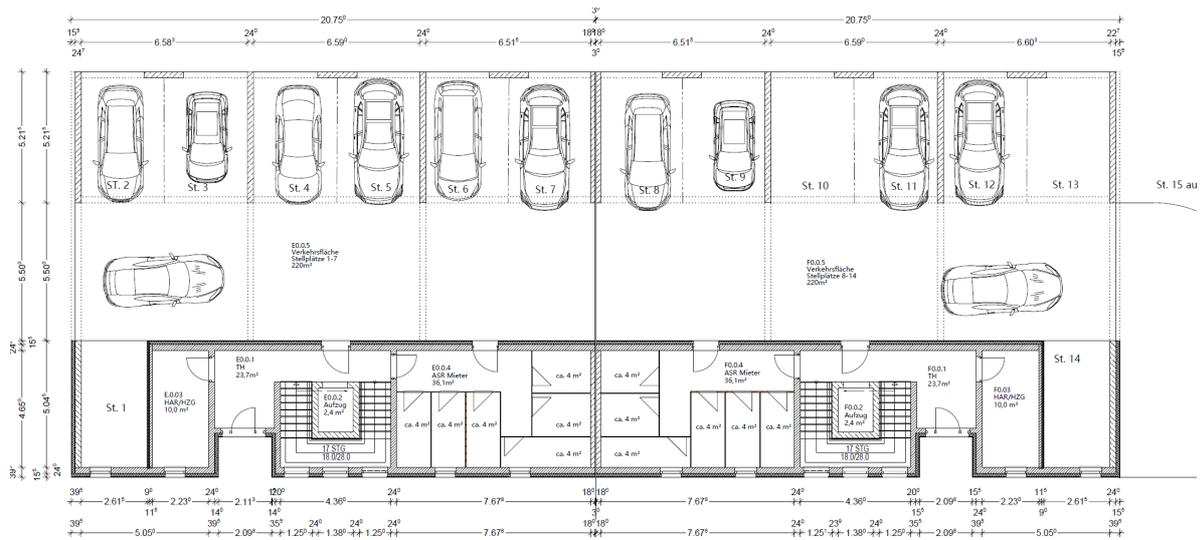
Erdgeschoss mit Darstellung der Stellplätze
